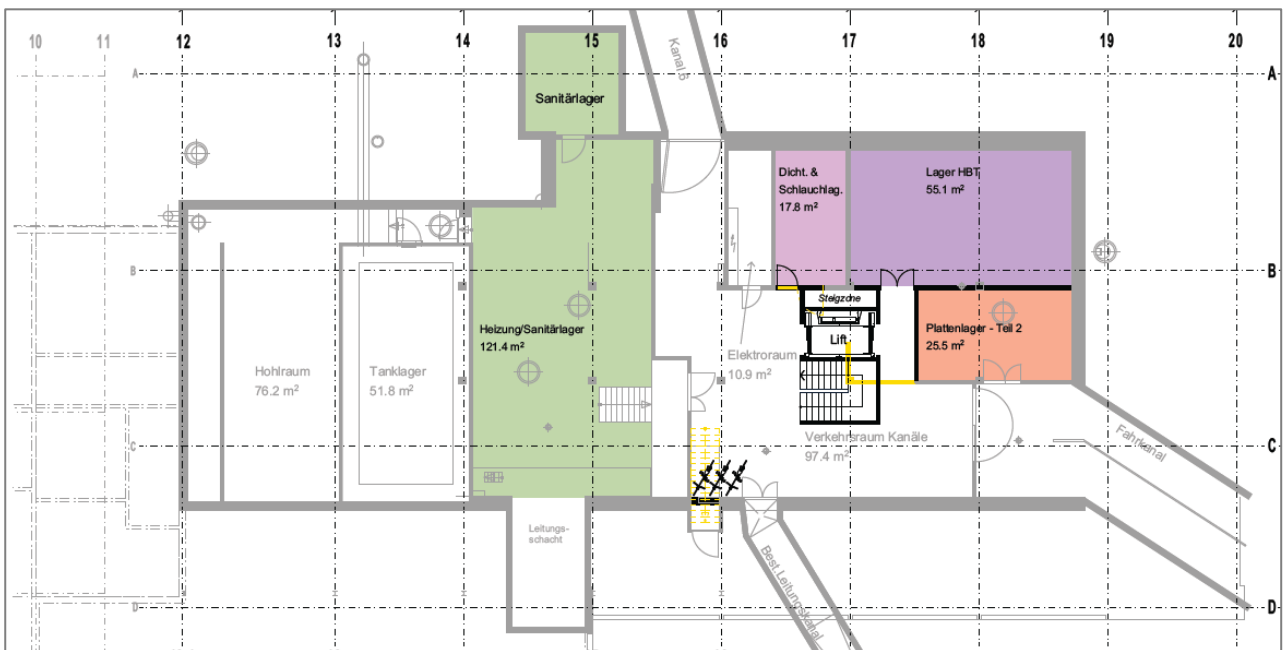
Grundriss 3.UG. (Umbau) mit schematischer Angabe der Nutzungen. Oben in der Mitte ist die Tunnelverbindung zu LU27 erkennbar, unten rechts die Anlieferung LU27
